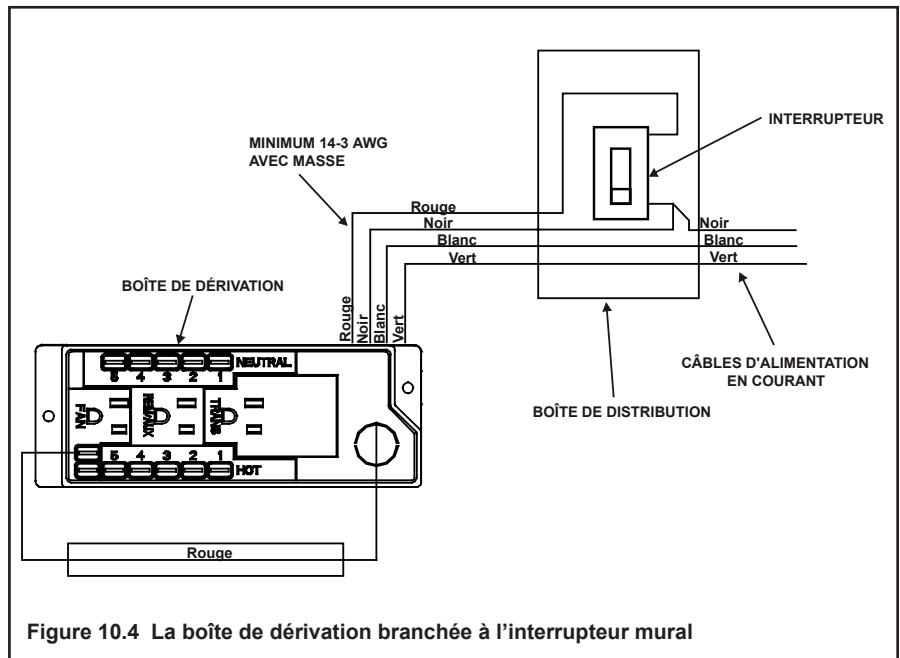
La boîte de dérivation branchée à l'interrupteur mural
